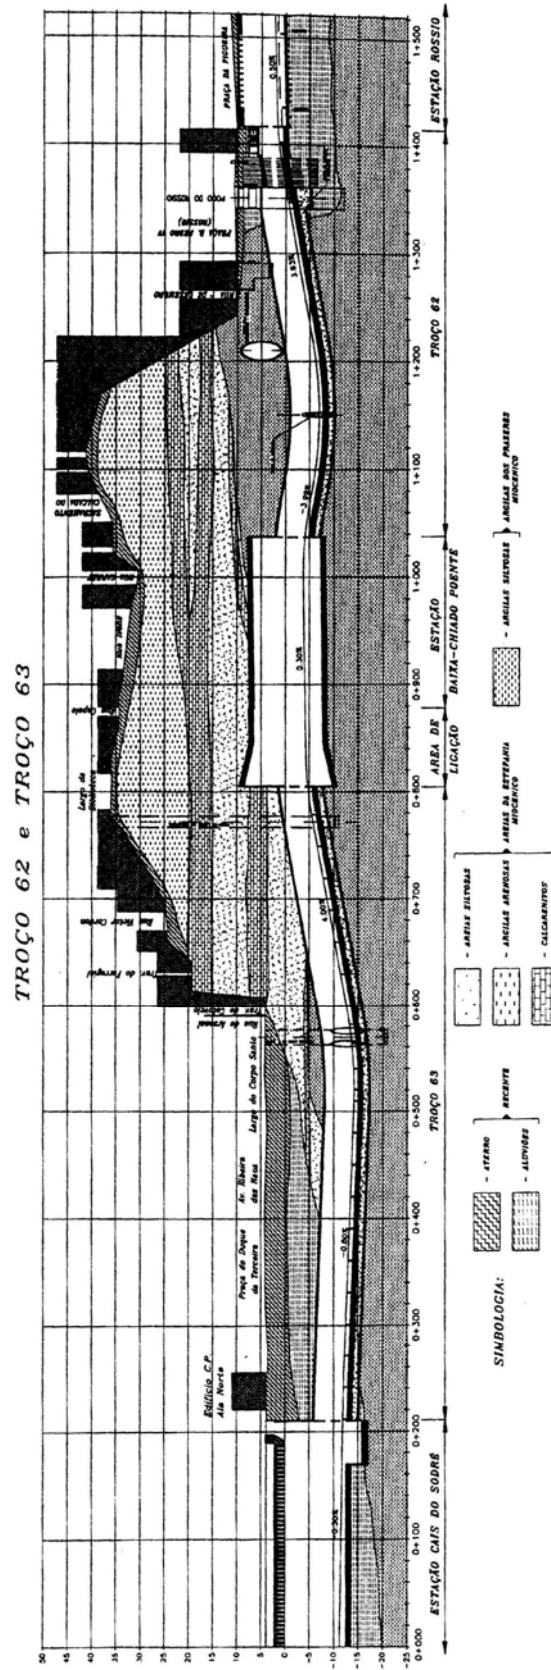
Perfil longitudinal dos troços 63 – Cais do Sodré – Baixa/Chiado e 62 Baixa/Chiado – Rossio
